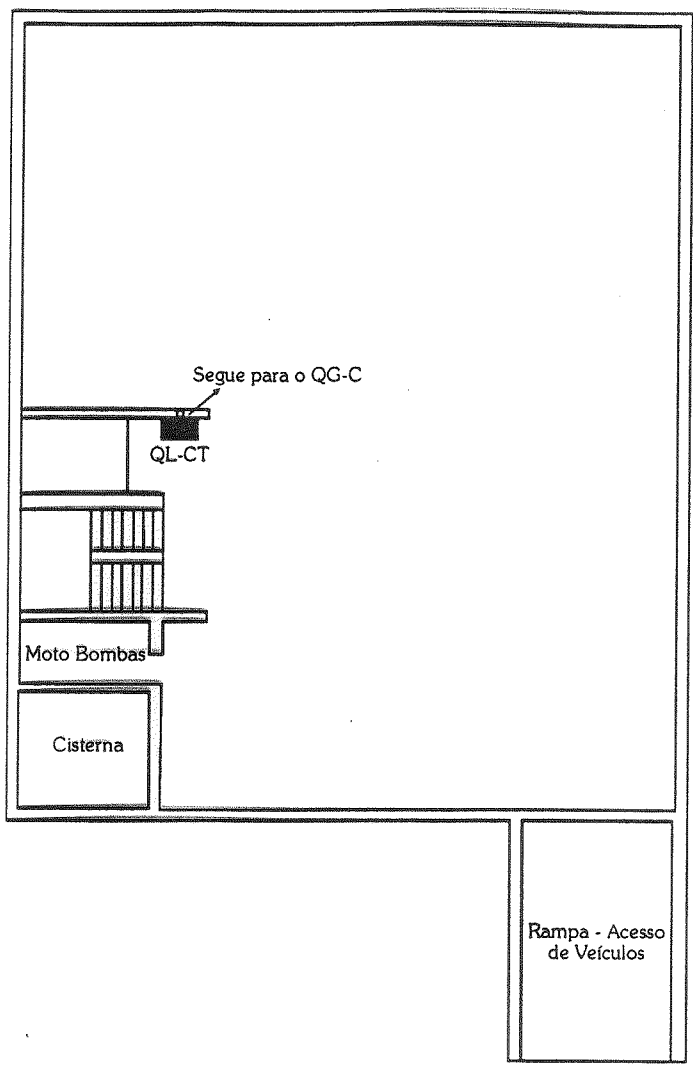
Edifício de Apartamentos - Planta Baixa do Subsolo
